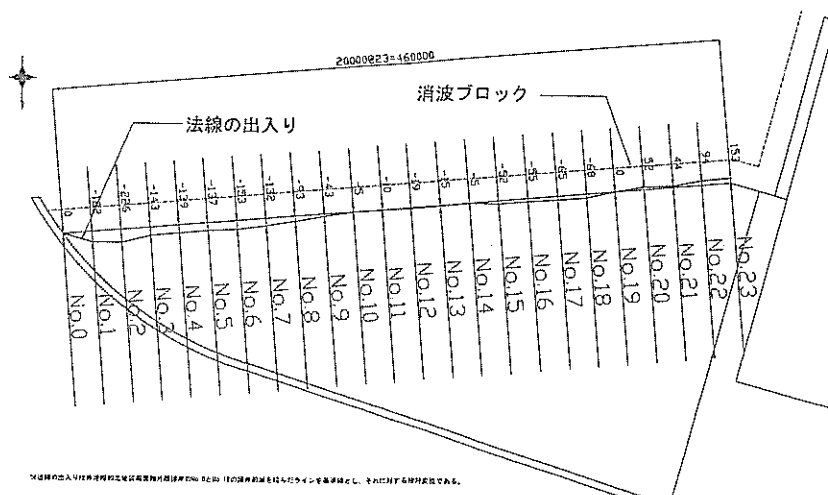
廃棄物外周護岸⑩ 平面図・法線の出入り
